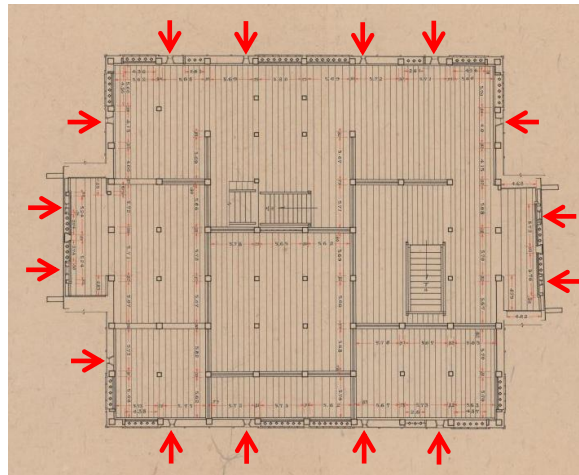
3階平面図 (部分) 姫路市立城郭研究所蔵
